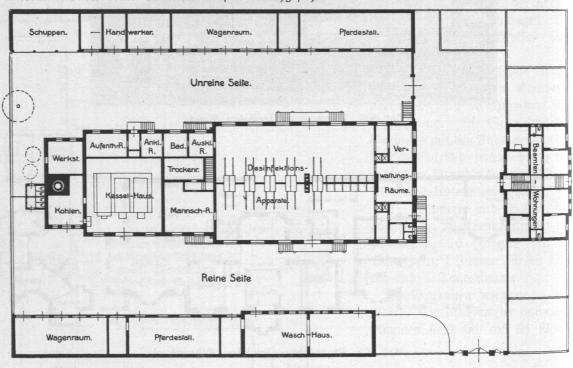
Desinfektionsanstalt I am Bullerbeich, Lageplan.
